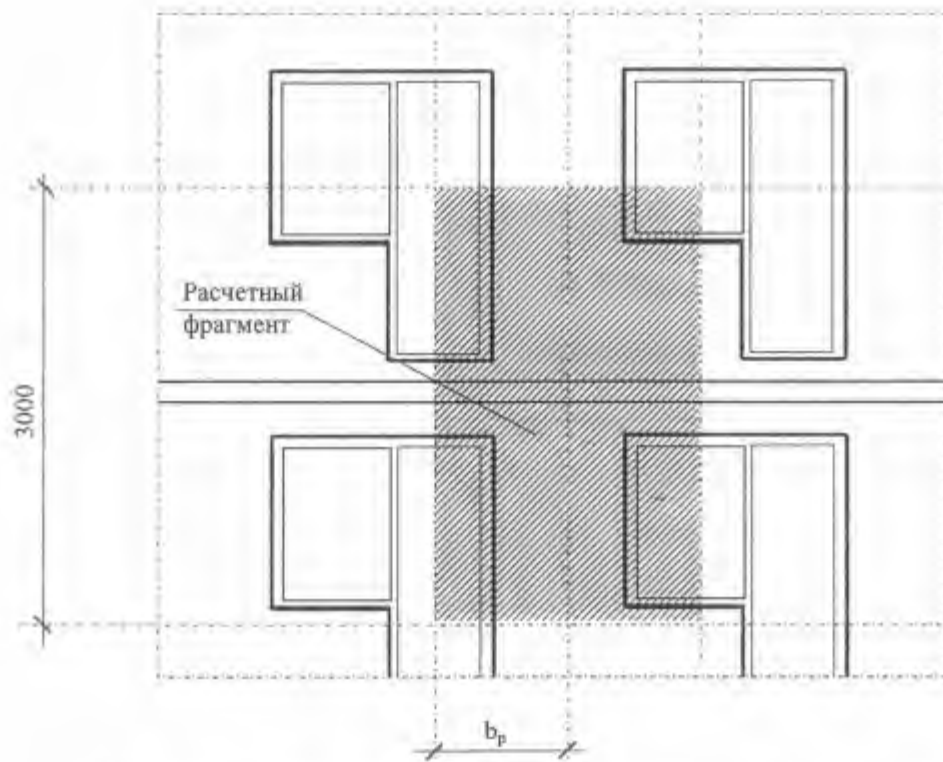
Расчетная схема фрагмента наружной стены здания для определения приведенного сопротивления теплопередаче участка с балконными дверьми (вид со стороны помещения)
